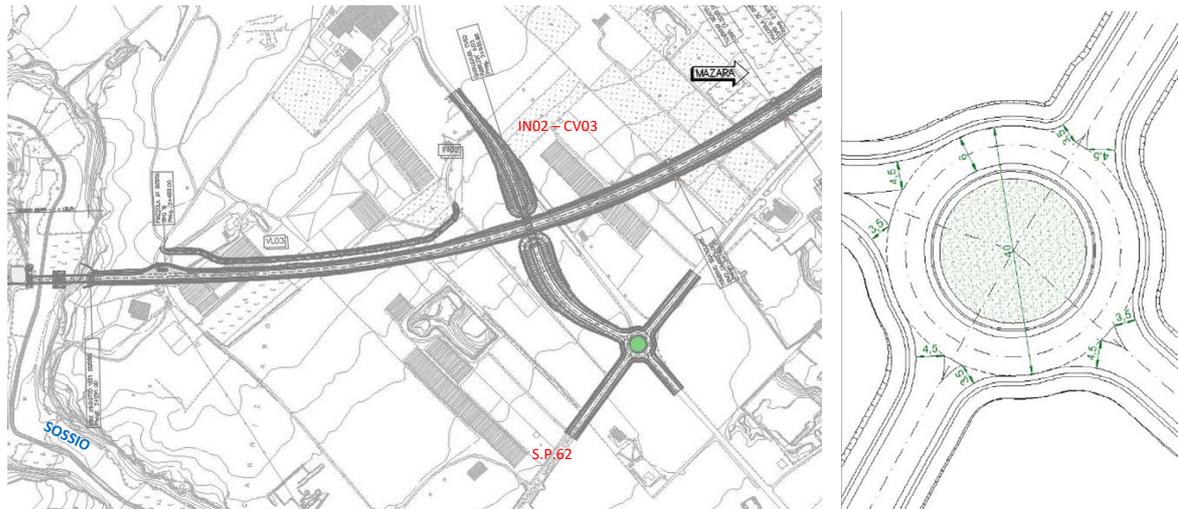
estratto planimetrico della Rotatoria 3 tra viabilità IN02 (CV03) e S.P.62
